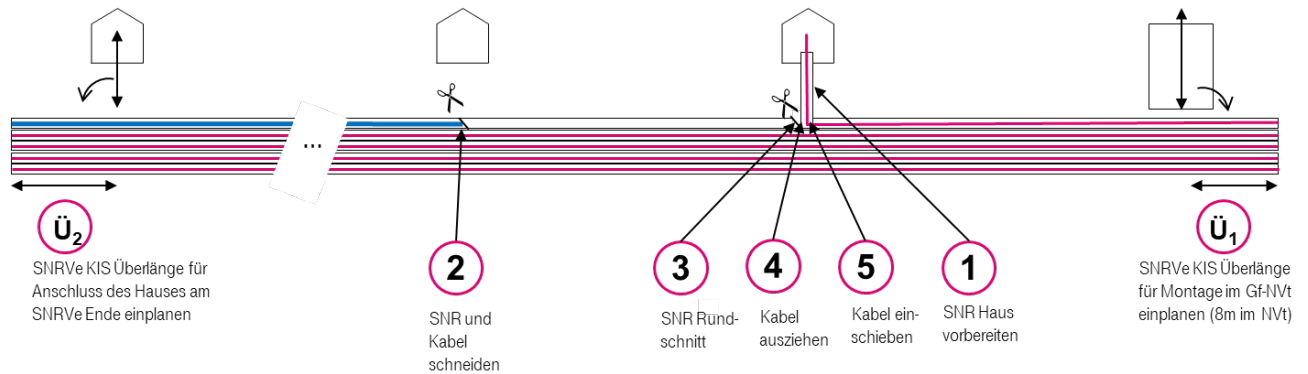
Regelbauweise Hausanschluss – prinzipieller Bauablauf
